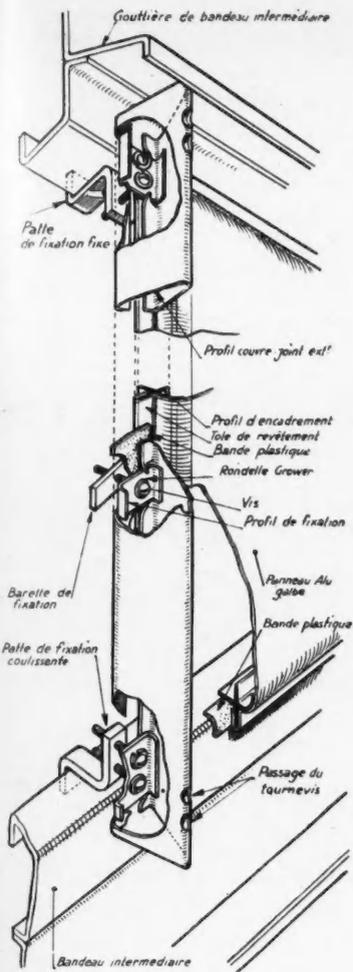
DETAIL DE LA STRUCTURE DES PANNEAUX GALBES EN ALLIAGE LEGER ET MONTAGE DES COUVRE-JOINTS.
